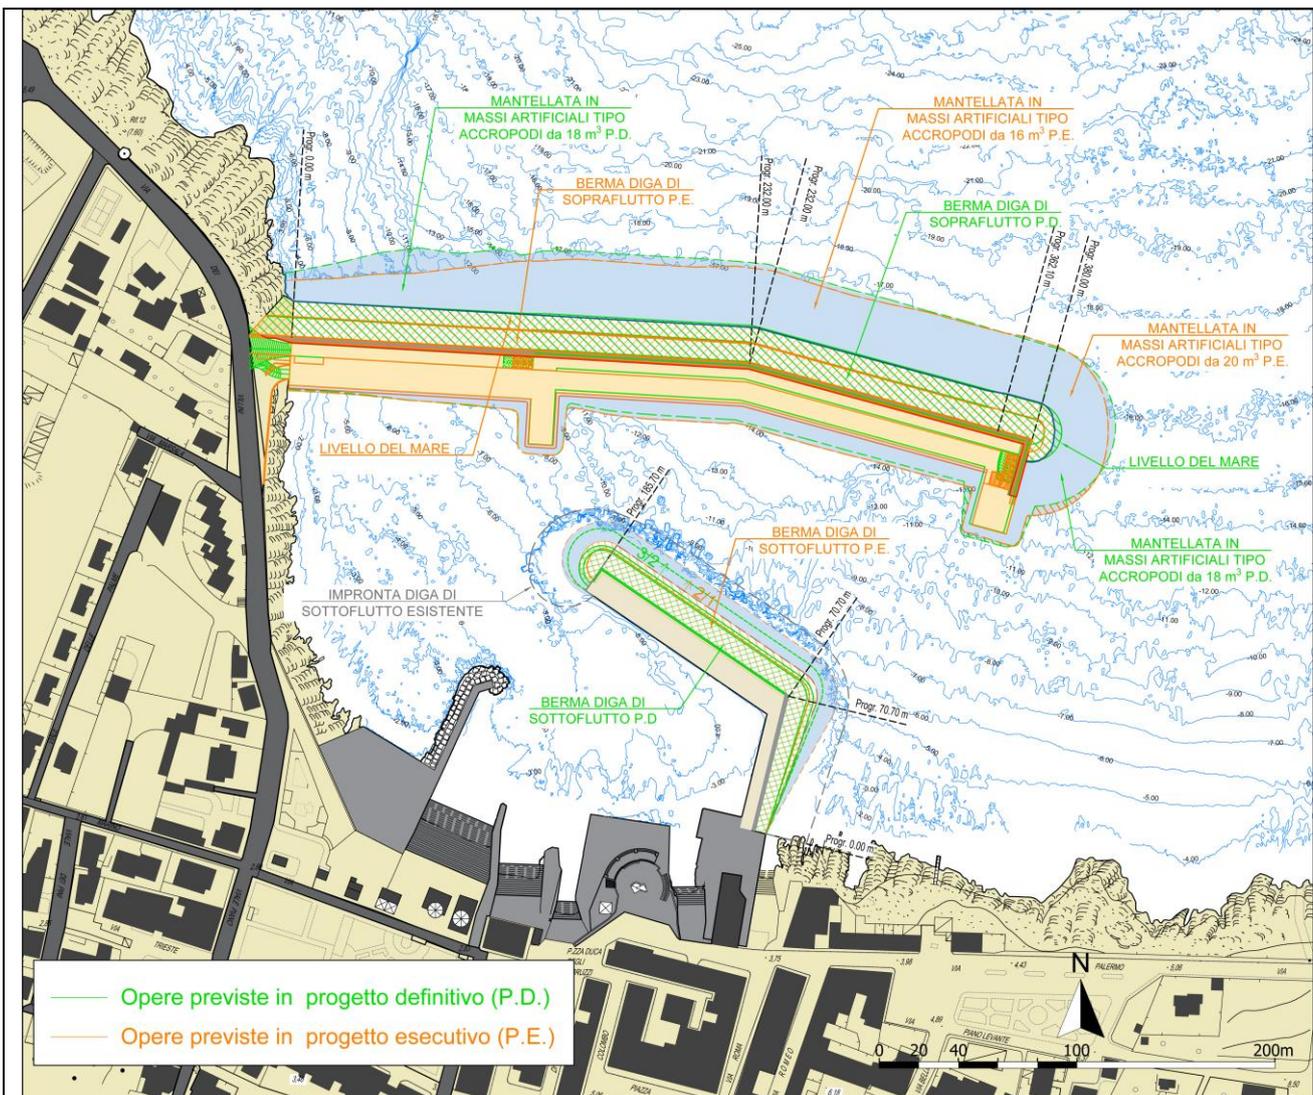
Planimetria raffronto opere in P.D. ed opere in P.E.
